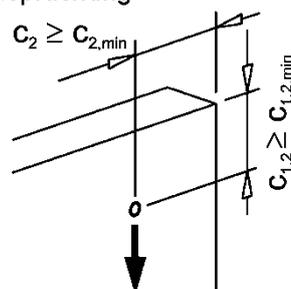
Einbauzustand Querbeanspruchung ohne Betonkantenbruch, ohne Rückhängebewehrung
